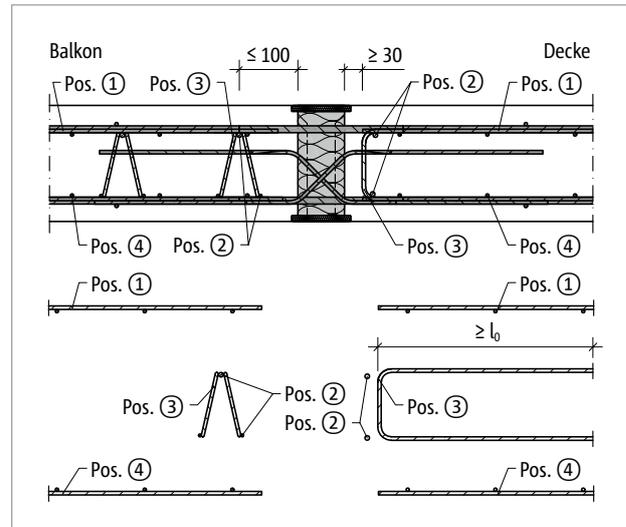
Schöck Isokorb® T Typ D: Bauseitige Bewehrung mit Gitterträger
